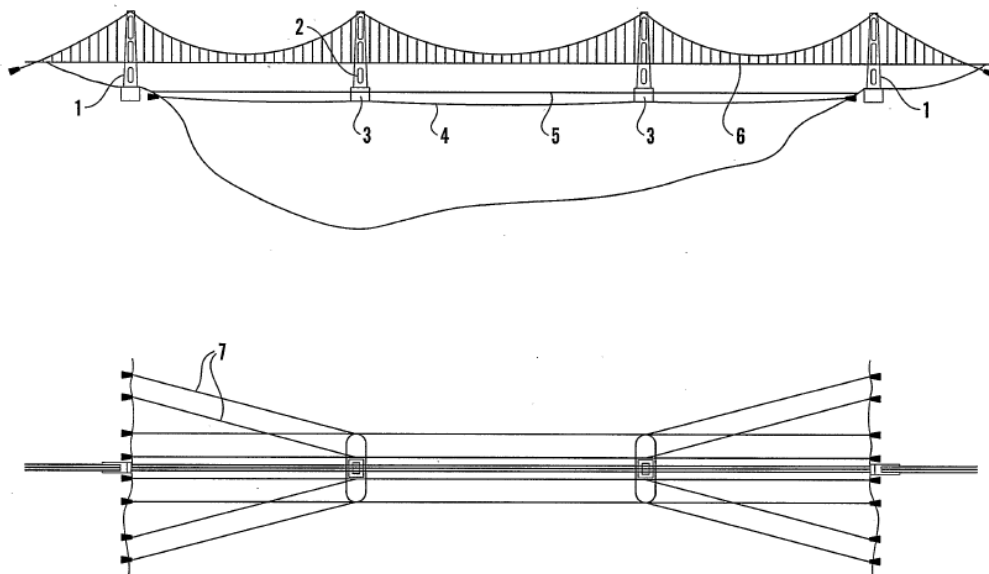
Ansicht und Grundriss, Variante 1a (Aardal, 2005)
